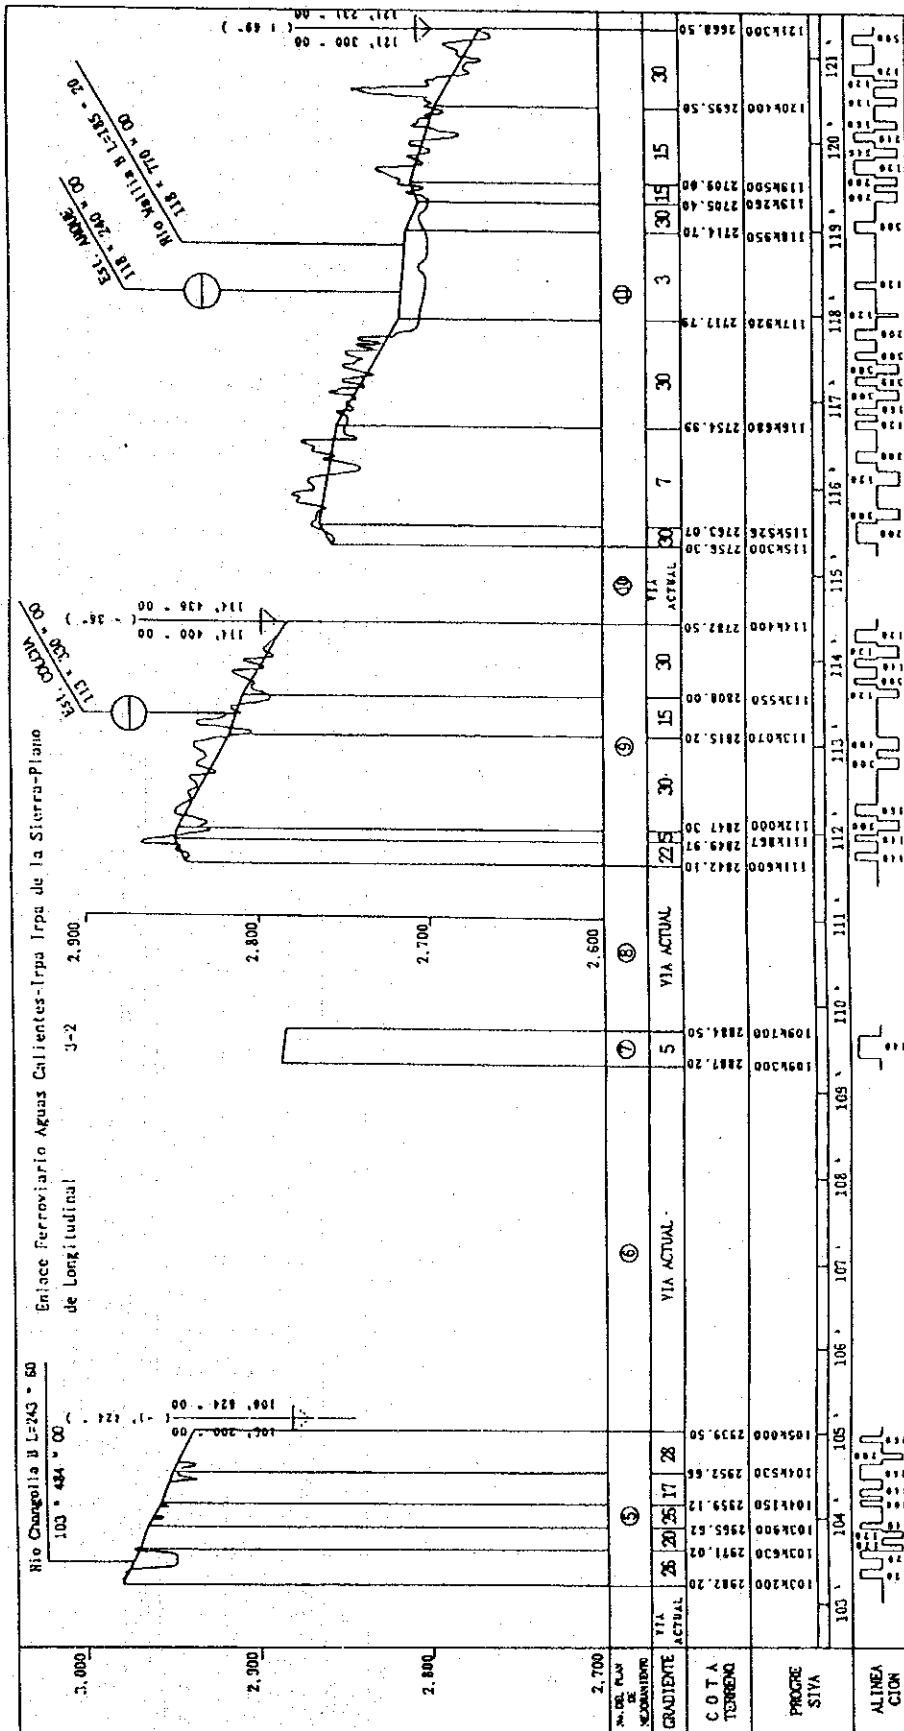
Perfil de Vía del Plan de Mejoramiento de la Ferrovía Oruro-Cochabamba; Plano 2 de 3
